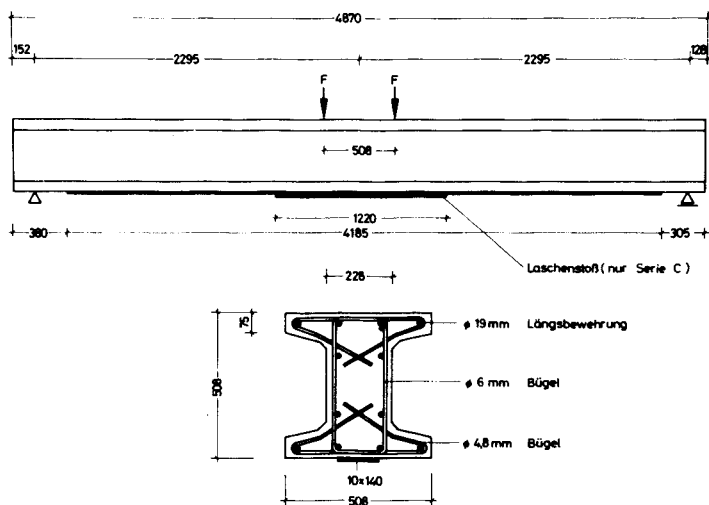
Stahlbetonbalken mit zusätzlicher aufgeklebter Bewehrung nach /29/ und /36/
